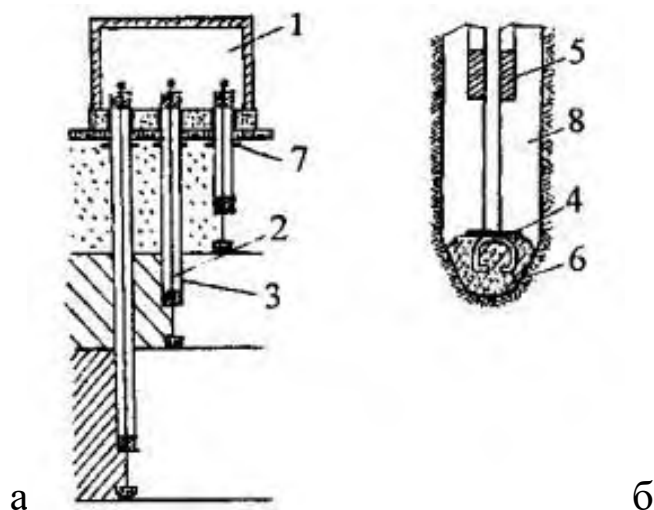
Глубинные трубчатые марки: а - схема расположения марок; б - заделка основания марки; 1 - защитный колодец; 2 - рабочая труба; 3 - защитная труба; 4 - опорный диск с арматурой; 5 - сальник; 6 - бетон; 7 - хомут; 8 - зазор
